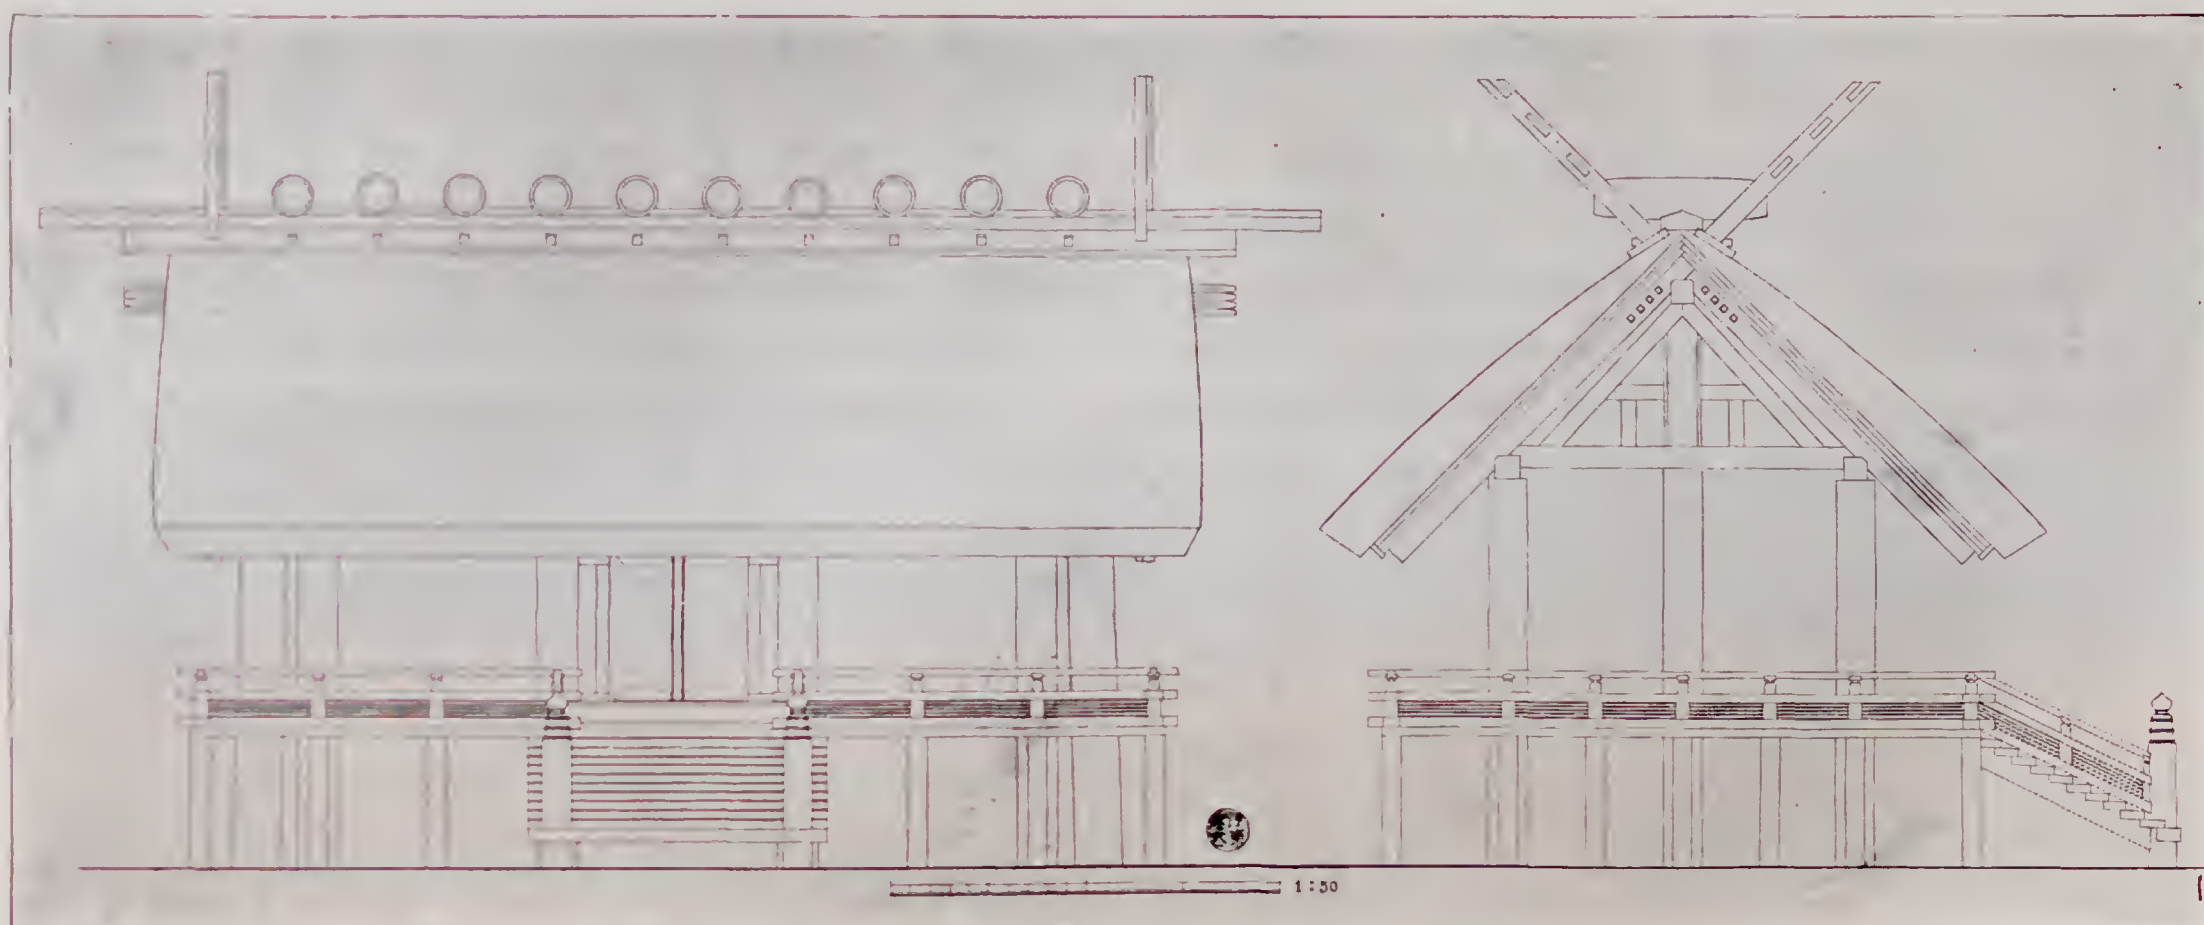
PLAN D'UN TEMPLE SHINTOÏSTE.
